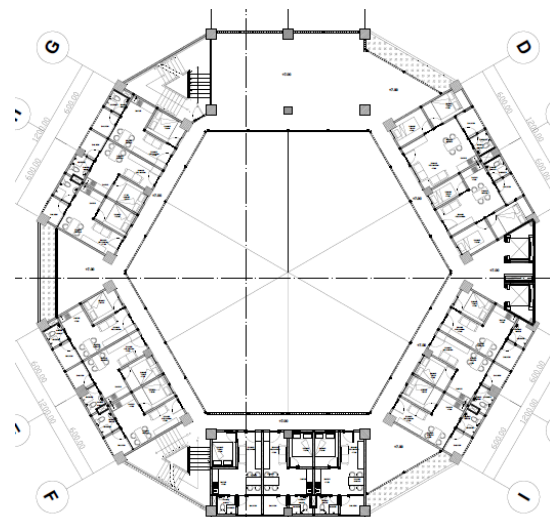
Denah Rencana Tapak Rusunawa Rancacili
